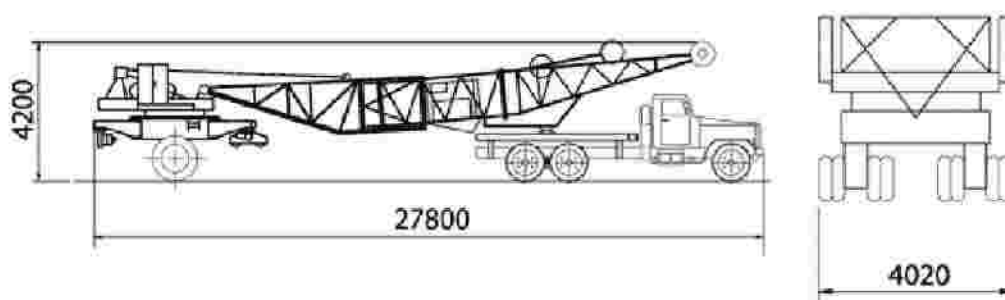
Перевозка башенного крана КБ-408.21
